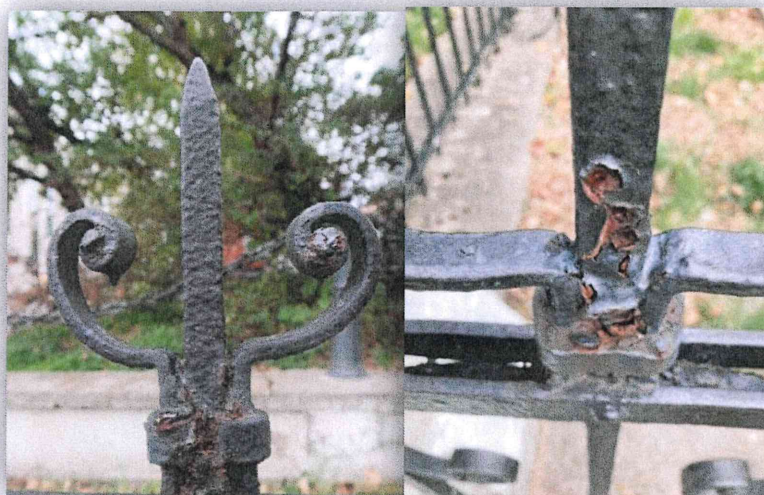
Stan zachowania murku zewnętrznego. Widoczne wadliwe naprawy wykonane w 2006 roku.
